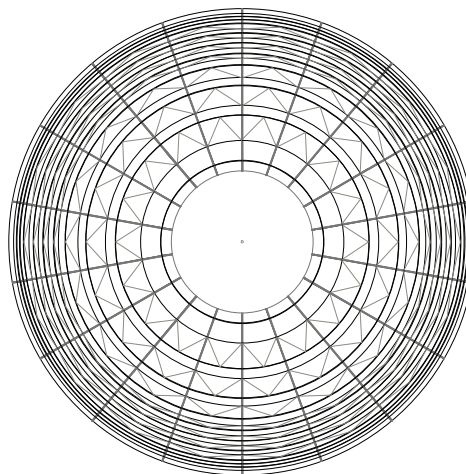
Planta indicando la pendiente. Elaboración propia.
